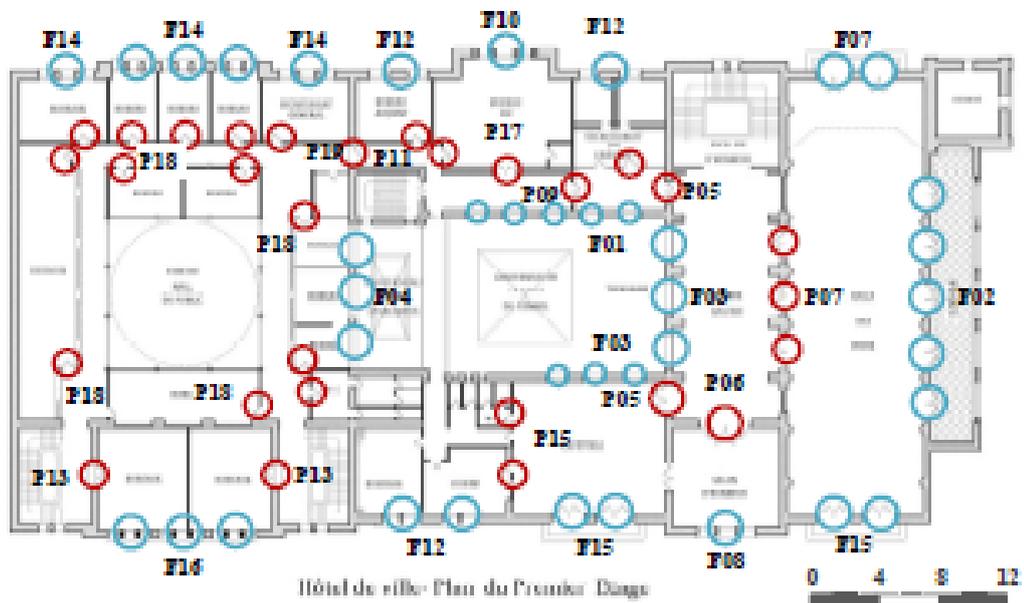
Plan de repérage des portes et fenêtres du premier étage, hôtel de ville de Skikda .
